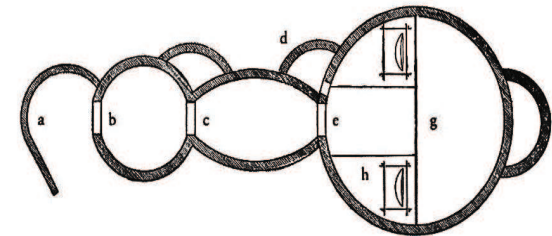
Grundriss eines mehrteiligen Iglus
